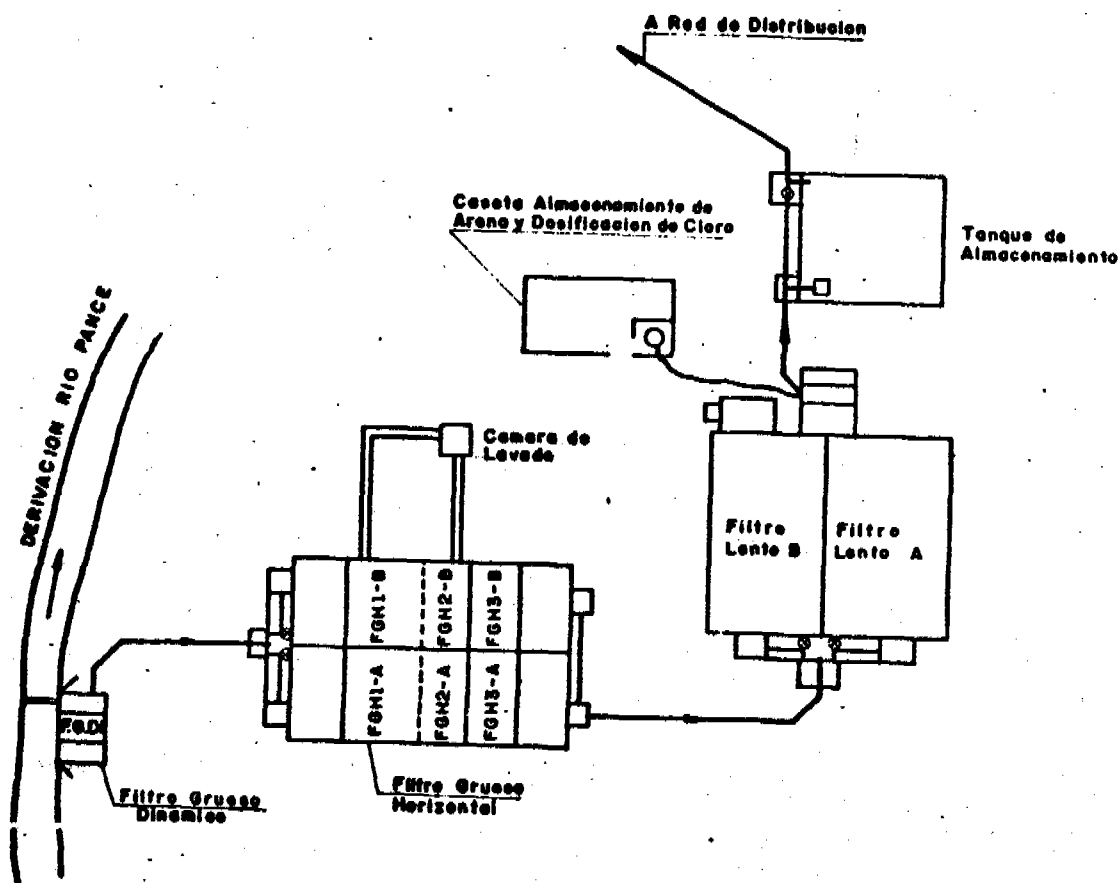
Planta de Tratamiento Derivación B del Río Pance. (CINARA/IRCWD, 1989).
